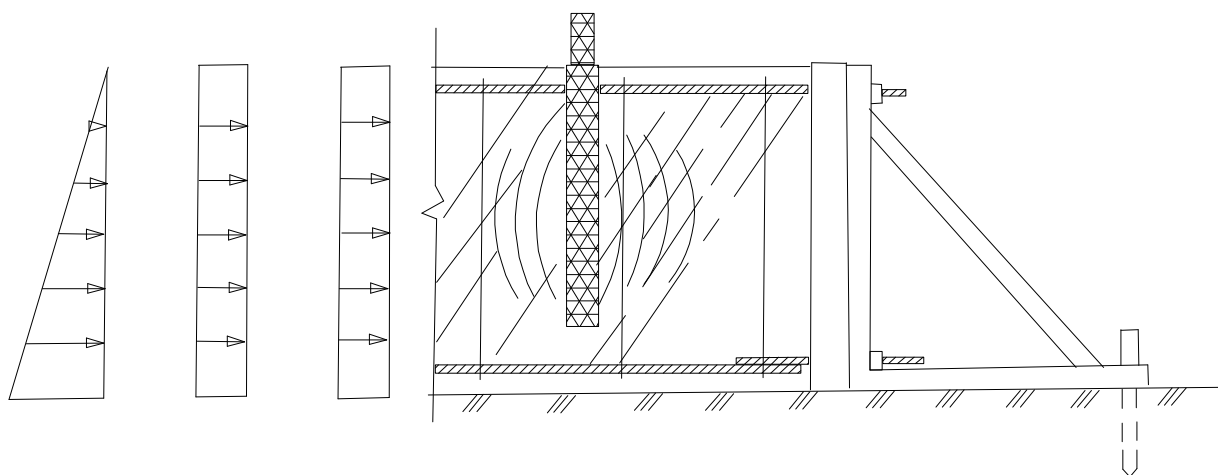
Расчетно-конструктивная схема опалубки фундаментной плиты
